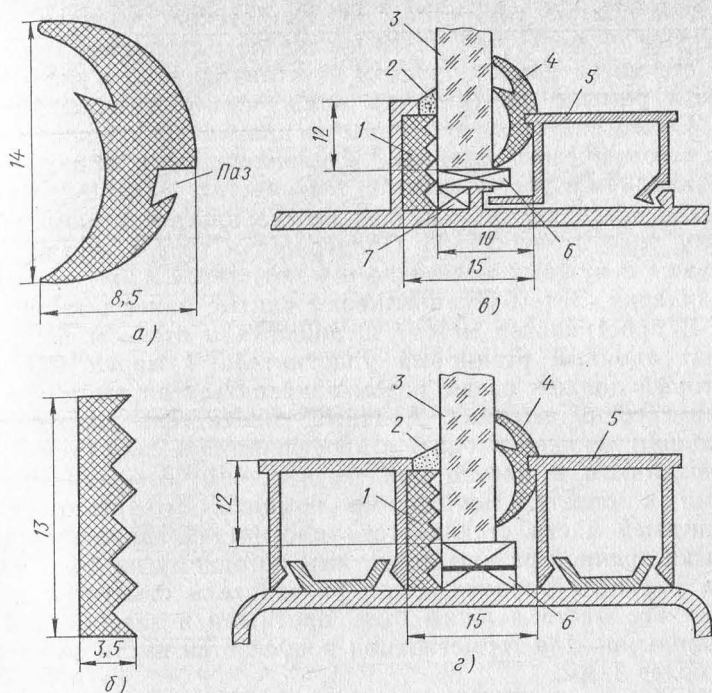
Вставка стекла на резиновых уплотнителях РЦ-1 и РЦ-5:
